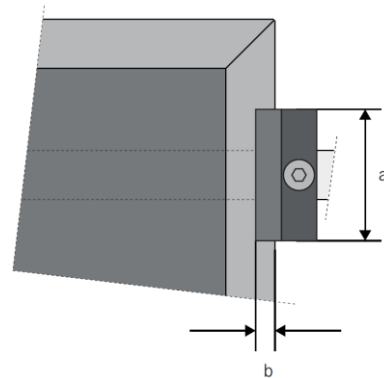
Définition de longueur et de profondeur de serrage des modules cadrés
